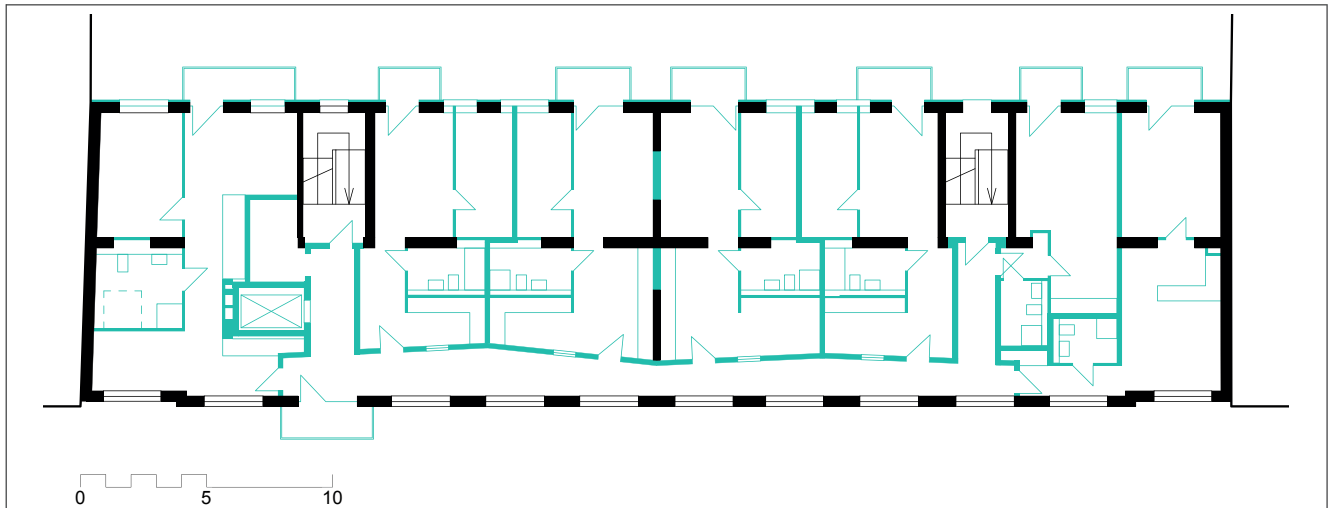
Grundriss des 3. OG mit Hervorhebung der Umbaumaßnahmen (grün) © roedig.schop architekten, Bearbeitung subsolar
